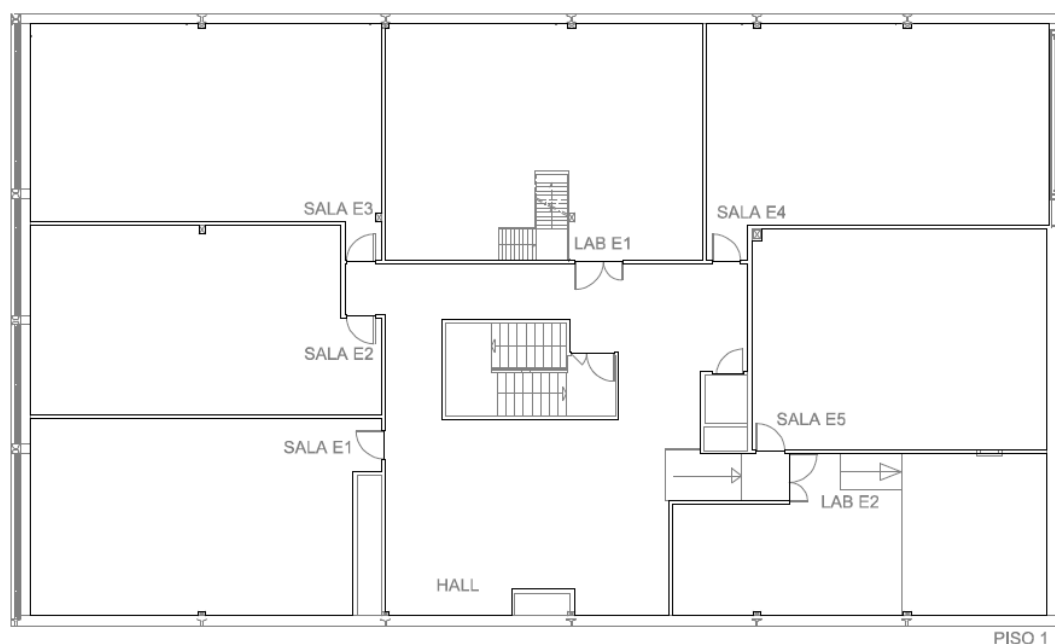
Planta do piso 1 do ECOTERMOLAB
